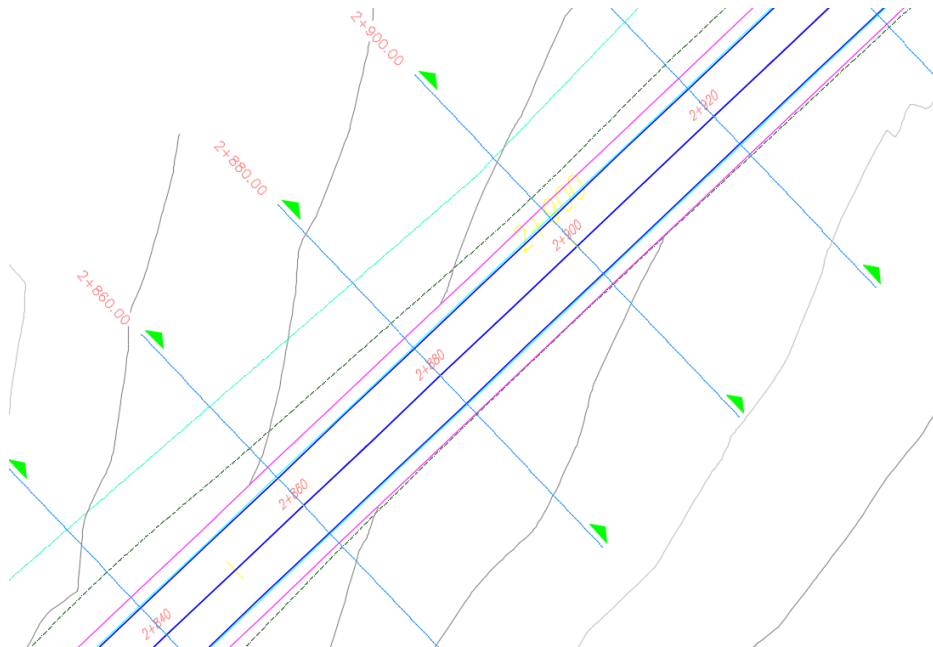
Líneas de Muestreo aplicadas cada 20 metros. Fuente: Acuña Xavier
